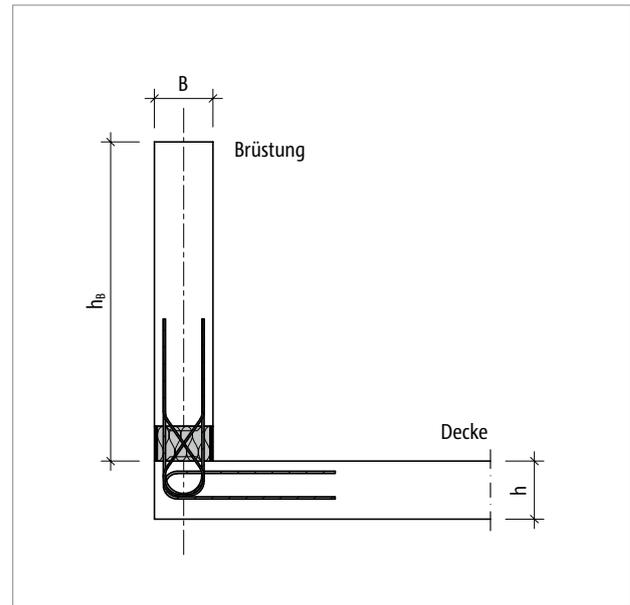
Schöck Isokorb® XT/T Typ A: Statisches System
